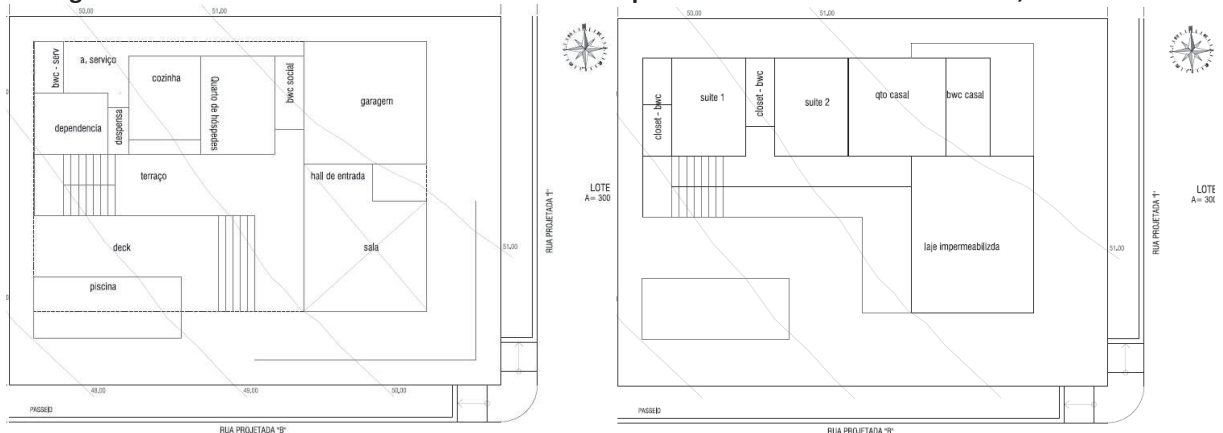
Zoneamento dos Pavimentos Térreo e Superior em CAD 2D – Profissional 02, Exercício 01.
